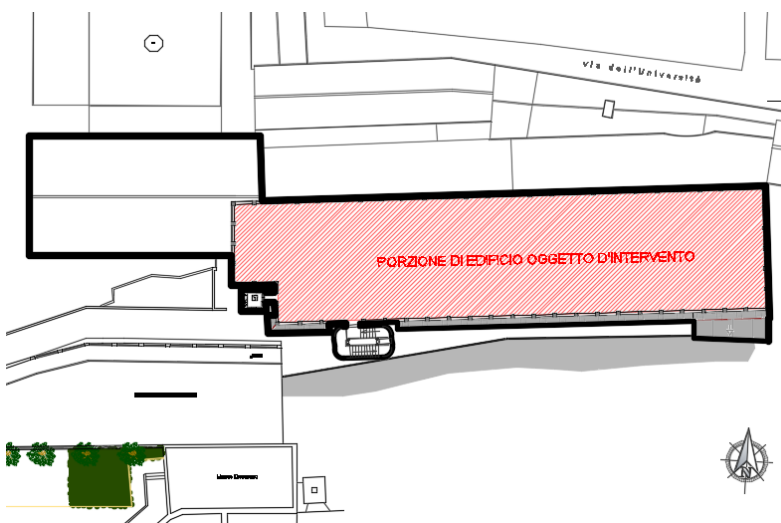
Planimetria generale, individuazione porzione di edificio oggetto d'intervento
